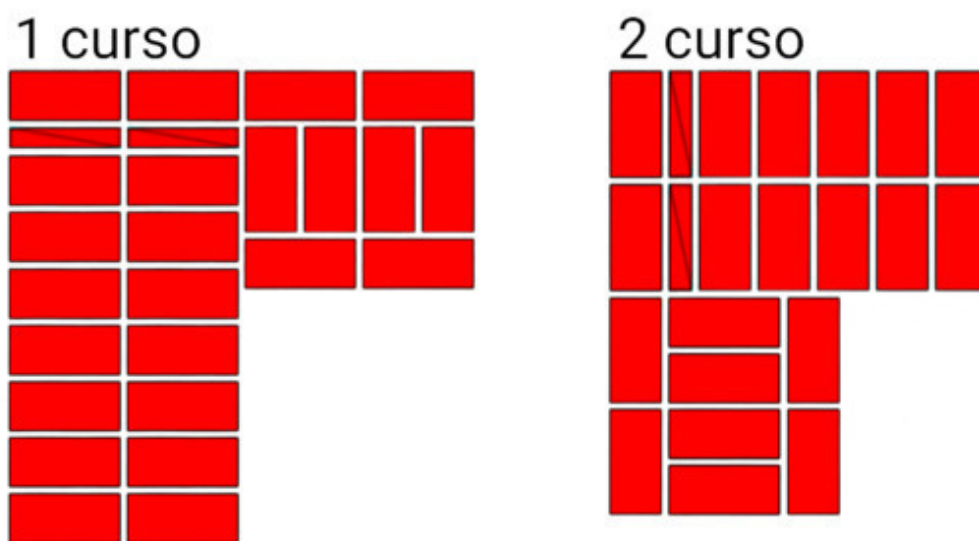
A ordem de colocar tijolos no canto das paredes. Espessura da parede 2 tijolos.
